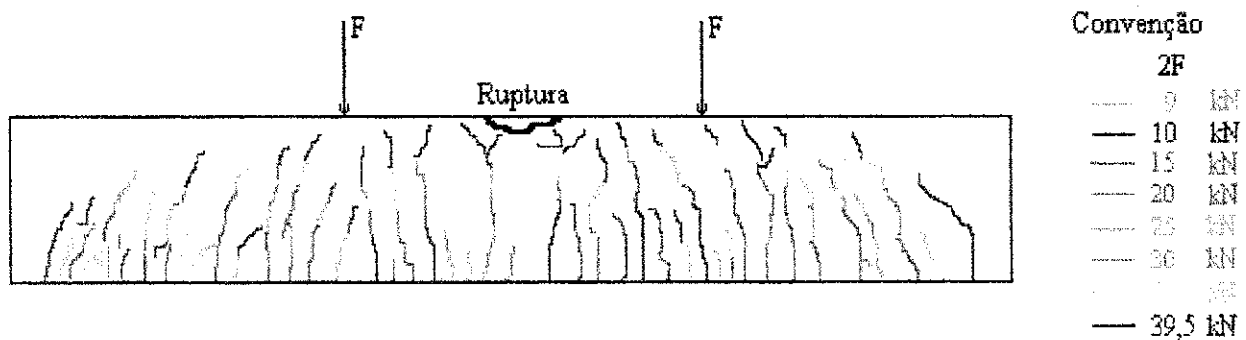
Evolução das Fissuras para a Viga VC-01
